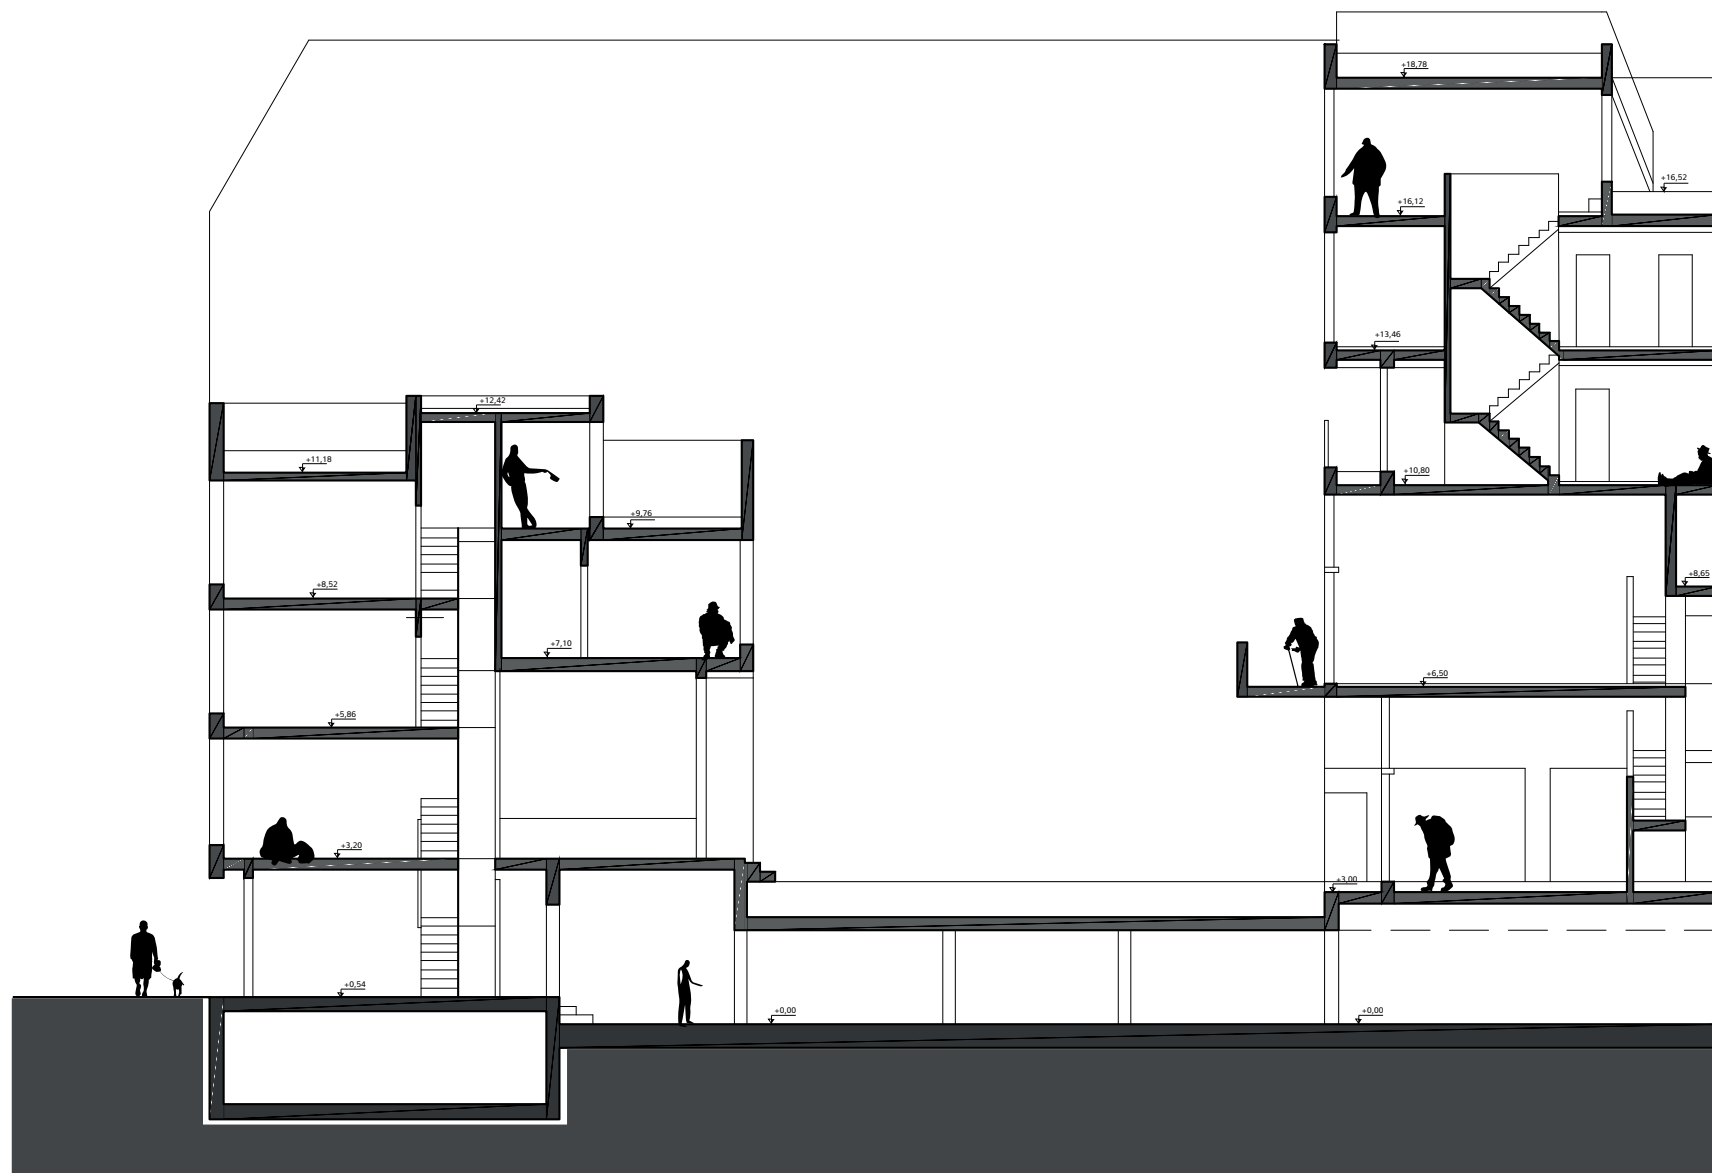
Corte AA - Segundo Bloco - GardenHouses & PentHouses.
